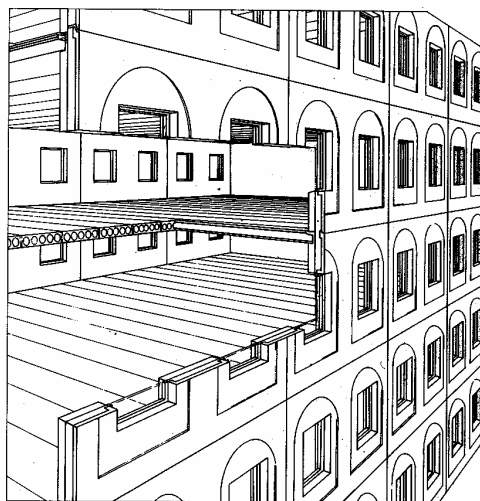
vista esquemática de um edifício com painéis estruturais de fachada e compridos painéis para piso
